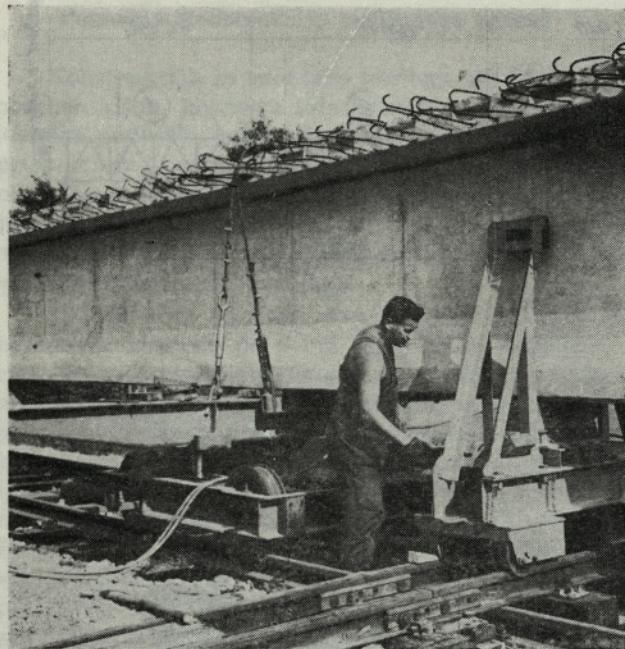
Vzdolžni pomik betonskega nosilca v jekleno konstrukcijo
